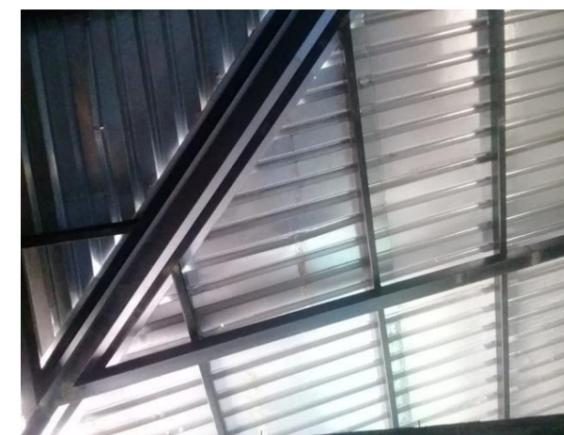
Estructura metálica y cubierta de zinc. Fuente: propia.
